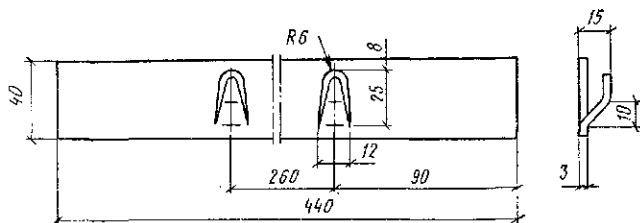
Кронштейн типа 22кс (масса 0,414 кг) для крепления высоко расположенных смывных бачков на кирпичных или бетонных стенах дюбель-гвоздями
